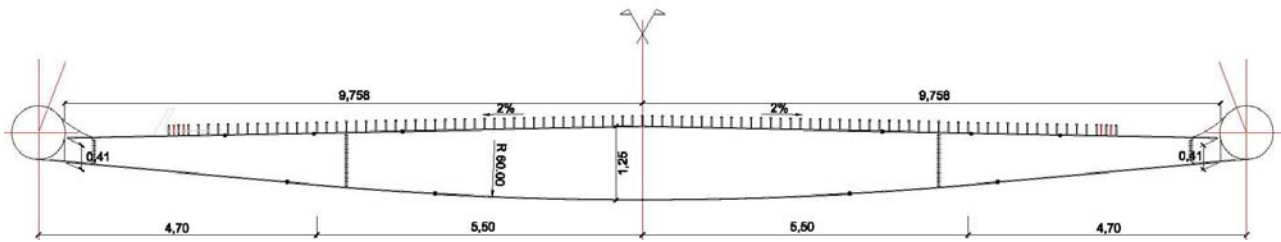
Detalle de una viga transversal tipo del tablero situada cada 5 m.
